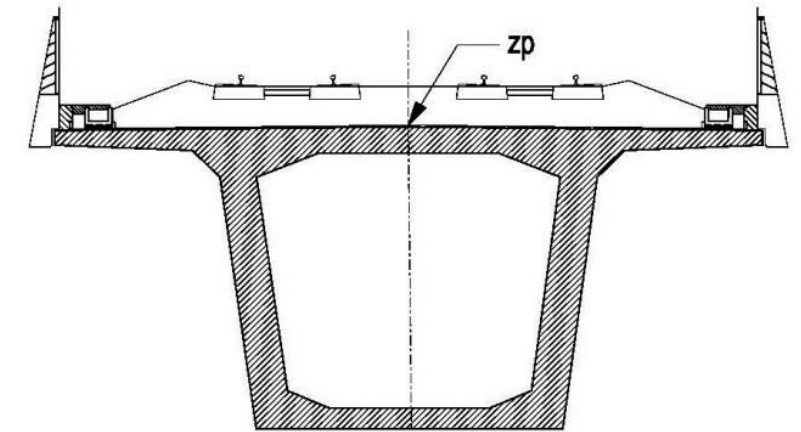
Coupe – Caisson béton précontraint (source : INGEROP)
